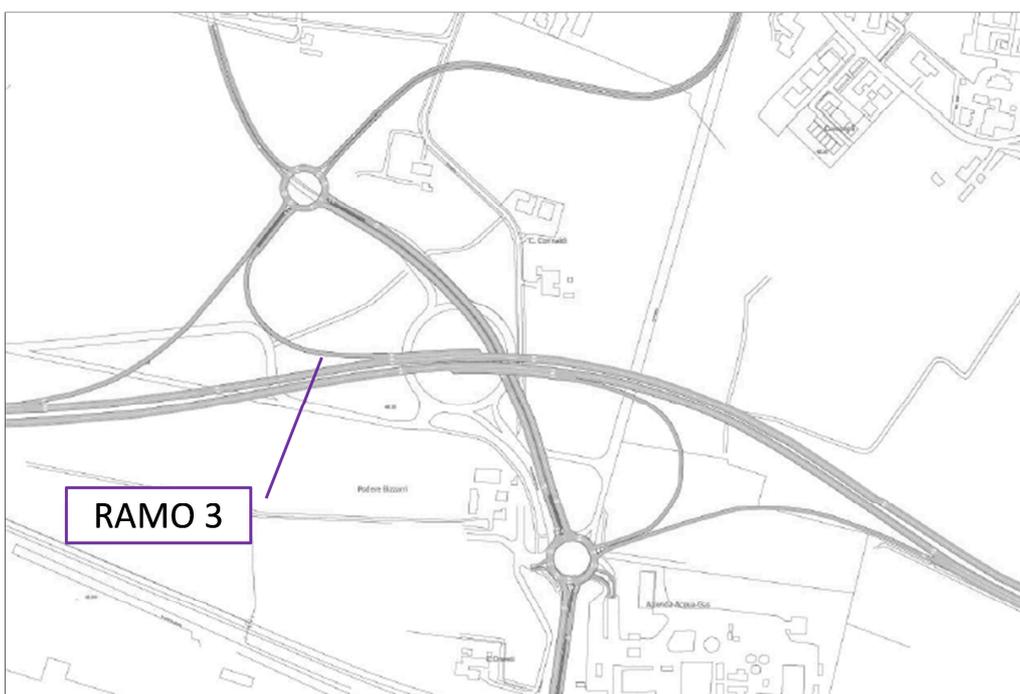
seconda alternativa proposta nel Progetto Definitivo
